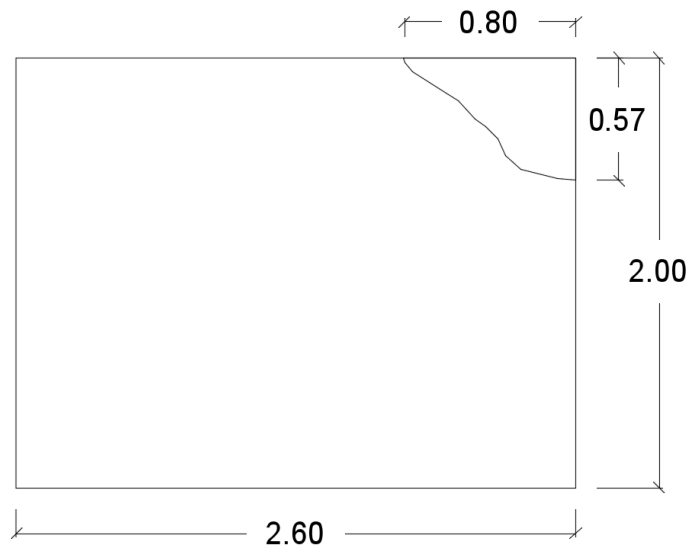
Esquema da localização da fissura da laje devido à queda parcial
